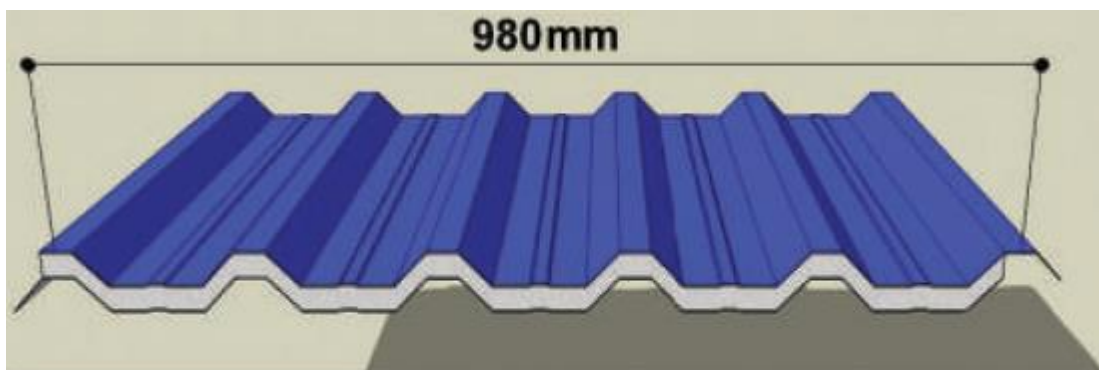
Telhas de aço trapezoidal, tipo sanduíche termoacústico - TR40
